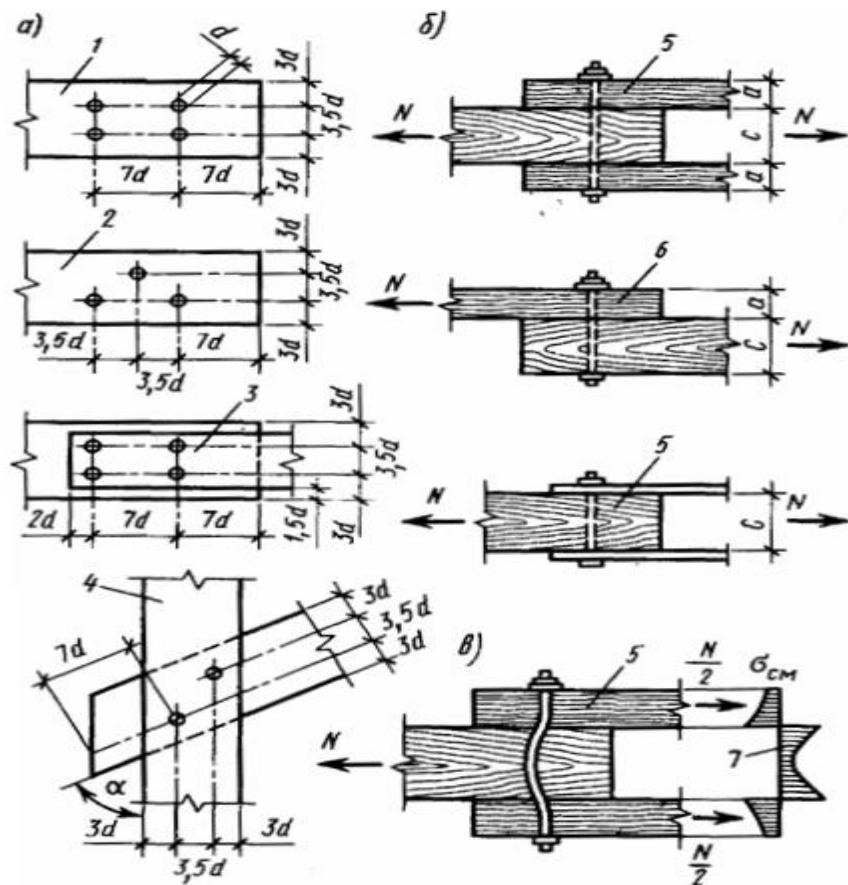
З'єднання на болтах, що згинаються: а — схеми розміщення; б — розрахункові схеми; в — схема роботи; 1 — пряме розміщення; 2 — шахове; 3 — при металевих накладках; 4 — в з'єднаннях під кутом; 5-симетричне ; 6 — несиметричне ; 7 — епюра напруг змінання деревини
